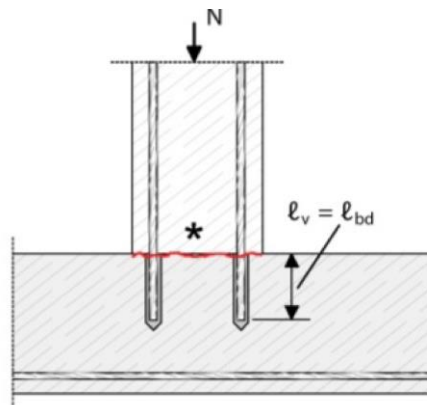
Нахлесточное соединение в фундаменте колонны или стены, где арматурные стержни находятся под растягивающим напряжением.
